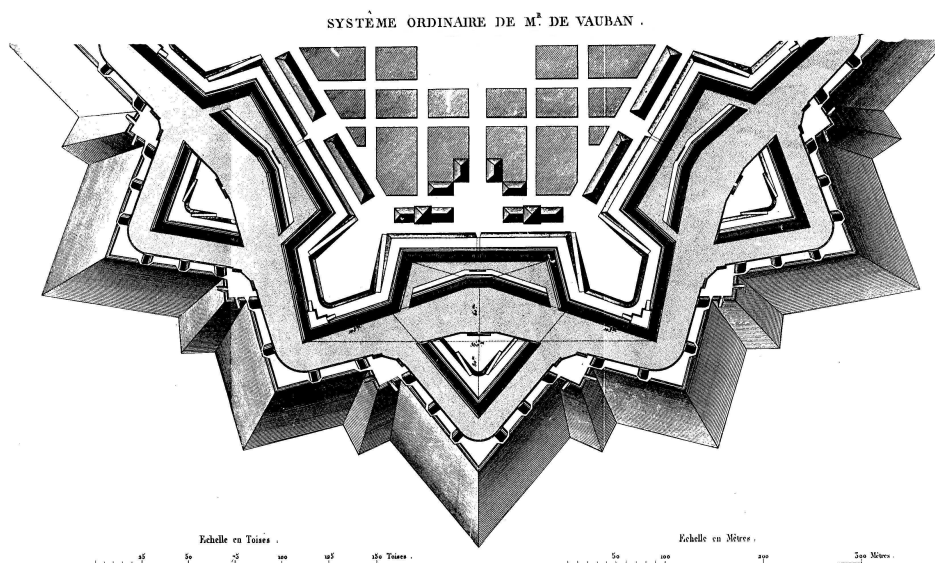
Planta del trazado tipo Vauban (1er Sistema)
